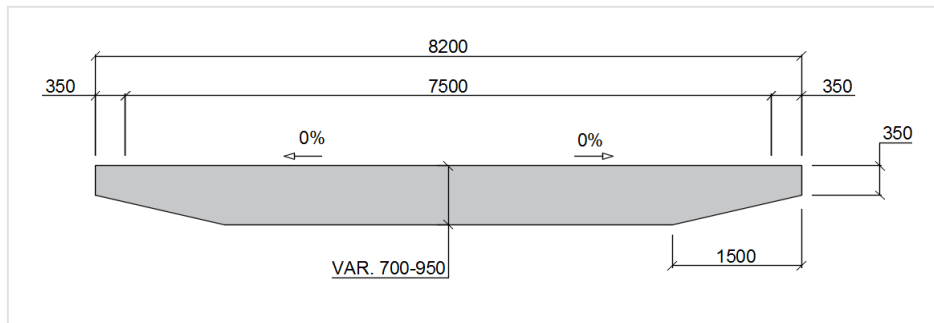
Platetverrsnitt i utgått håndbok, alle dimensjoner er i millimeter
